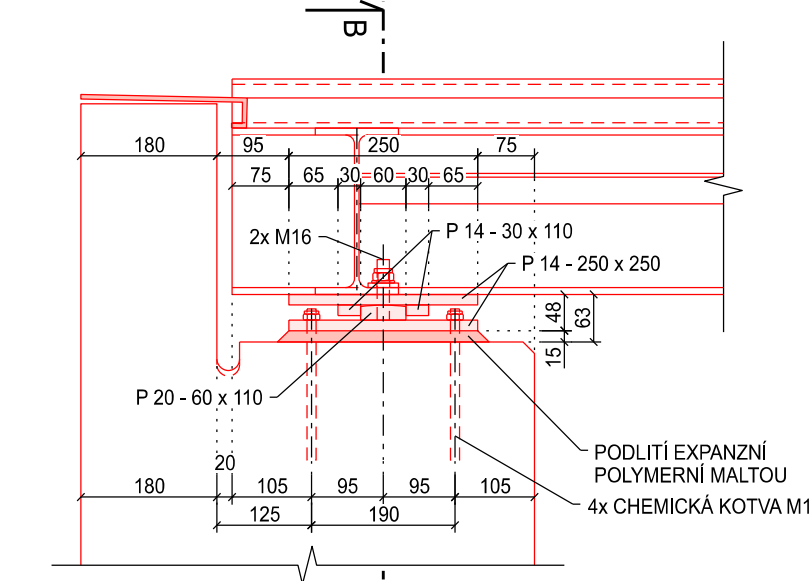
DETAIL PŘECHODOVÉHO PLECHU, 1:10
